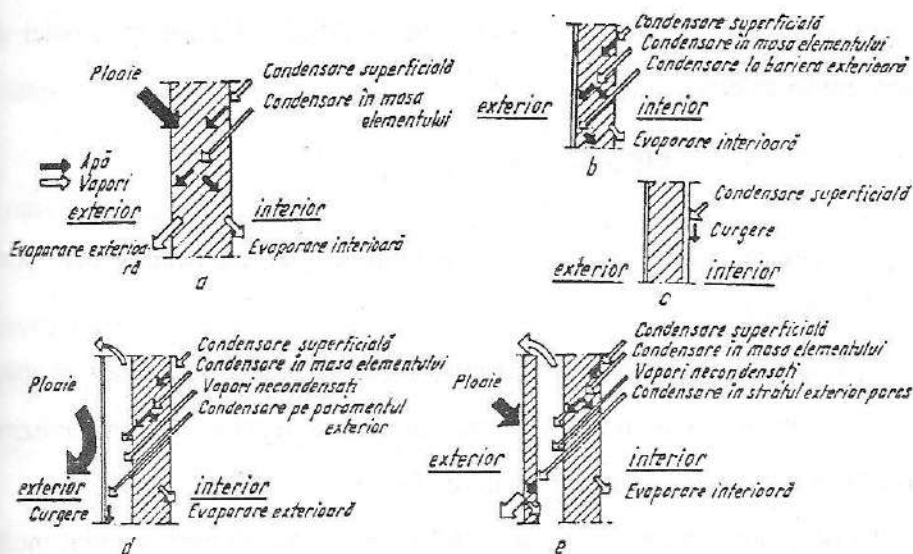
Condensarea vaporilor de apă în masa elementelor de construcție:
